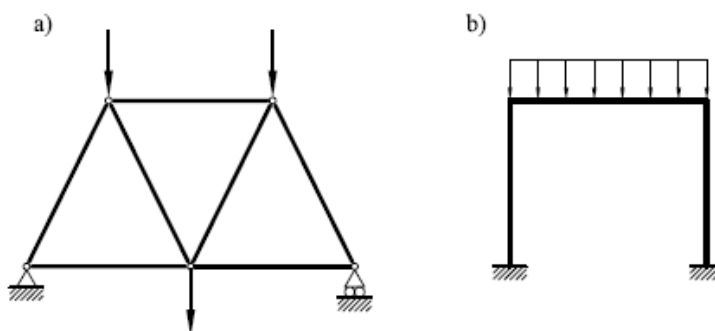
1 Tipos de estructuras a) articulada, b) reticulada
